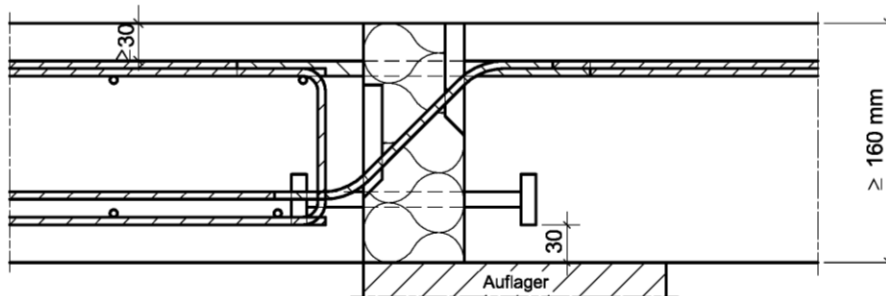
Beispiel Schöck Isokorb® Typ K mit Vertikalbewehrung
